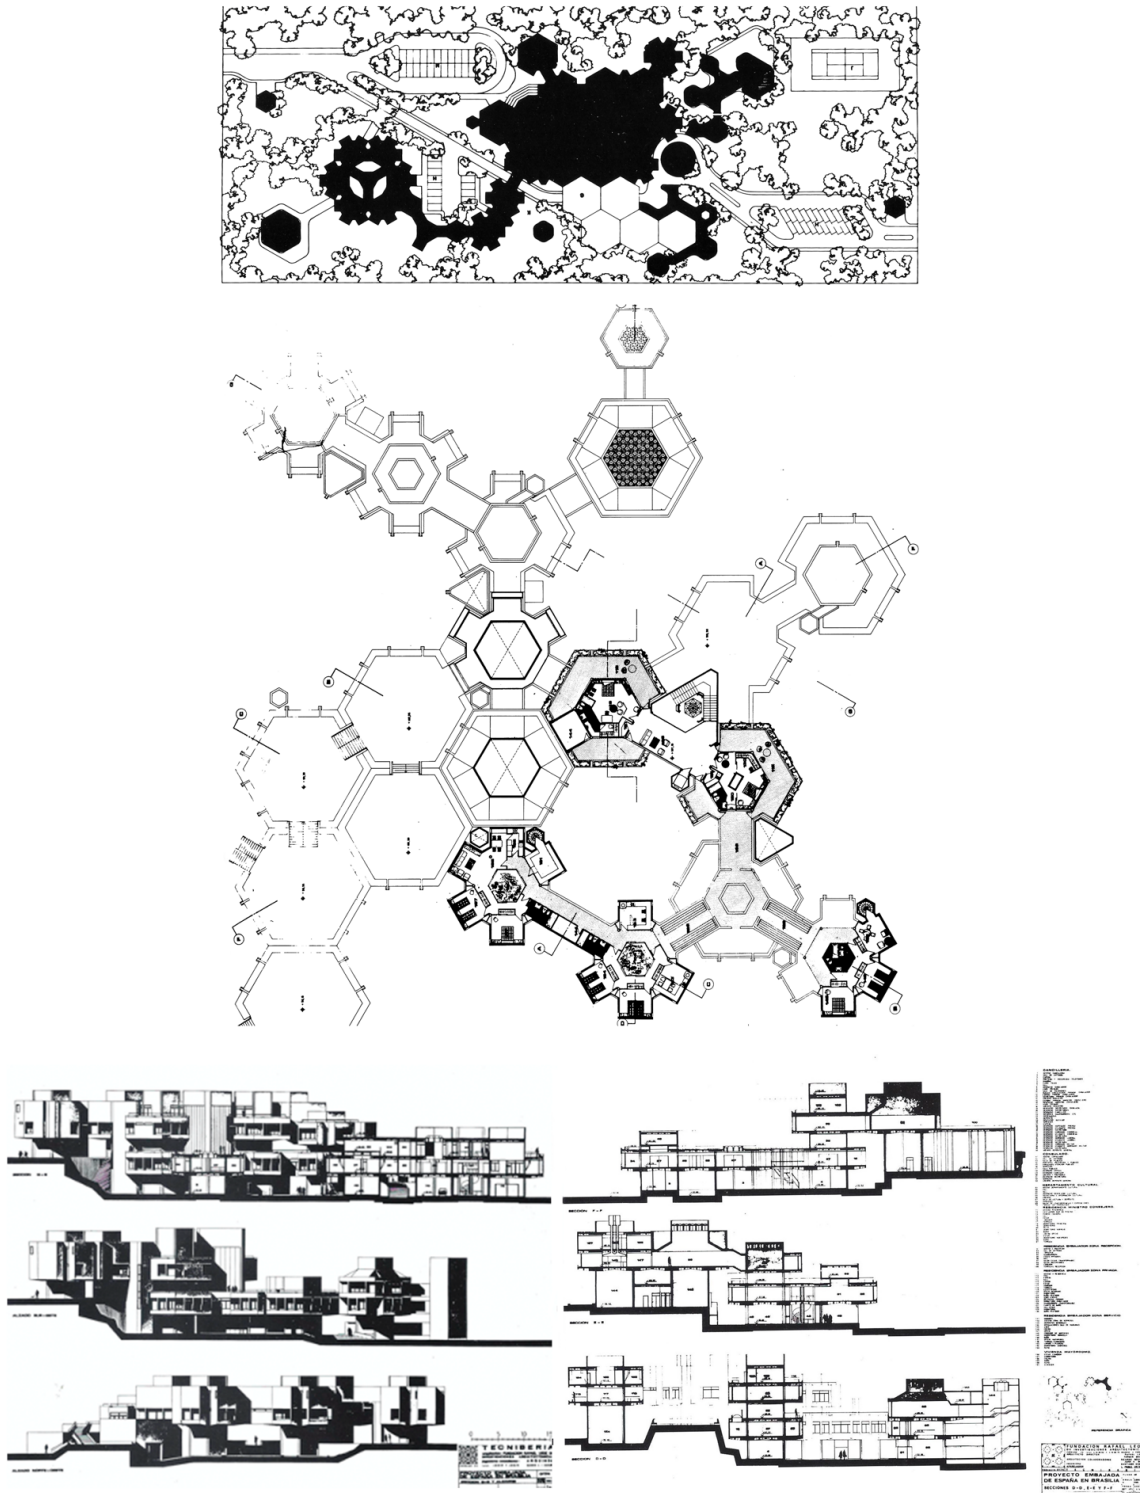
Planos Originales del Proyecto. *Arriba* Plano de emplazamiento. *Centro* Detalle en Planta. *Abajo Izquierda* Plano de Alzados del proyecto original. *Abajo derecha* Plano de secciones del proyecto original. Fuente: Catálogo RAFAEL LEOZ, exposición homenaje Abril-Junio 1978. Palacio de Velázquez del Retiro. Edita: Ministerio de Cultura, Madrid.
